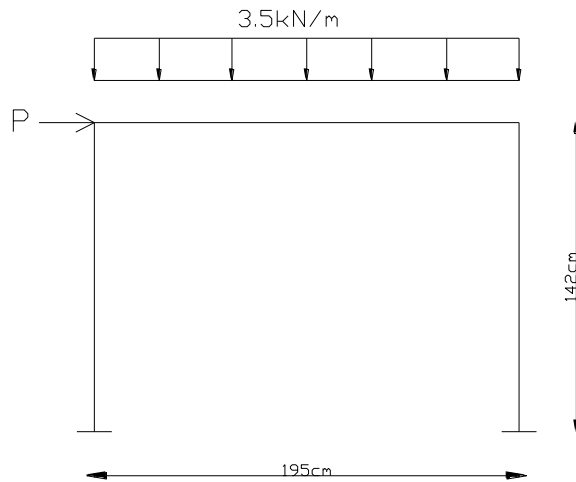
de geometrisi gösterilen tek katlı tek açıklı betonarme çerçeve sistem dikdörtgen kesitli kolonlar ve T kesitli kirişten oluşmaktadır. Donatı düzeninin kolon
